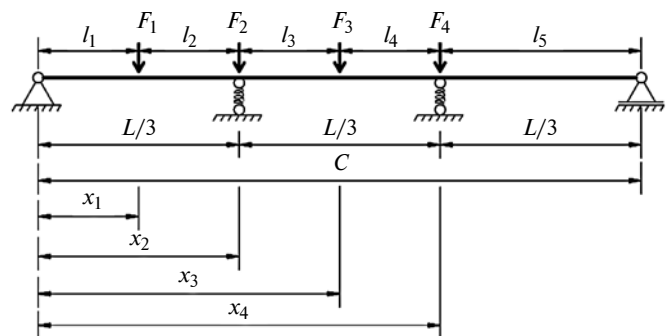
Расчетная схема дощатоклееной подкрановой балки с крановыми нагрузками
